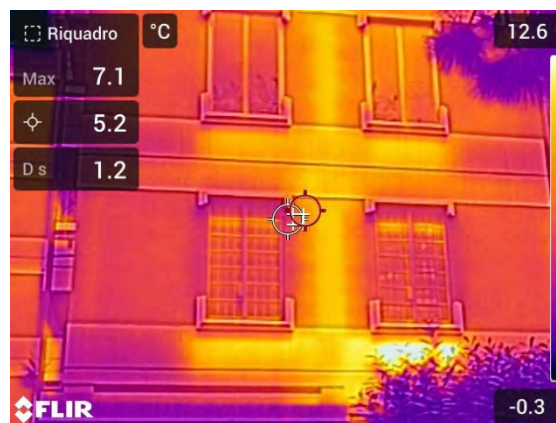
MCA\_1: condizioni di rilevazione attiva, fascia oraria 9-10. Prospetto nord.
